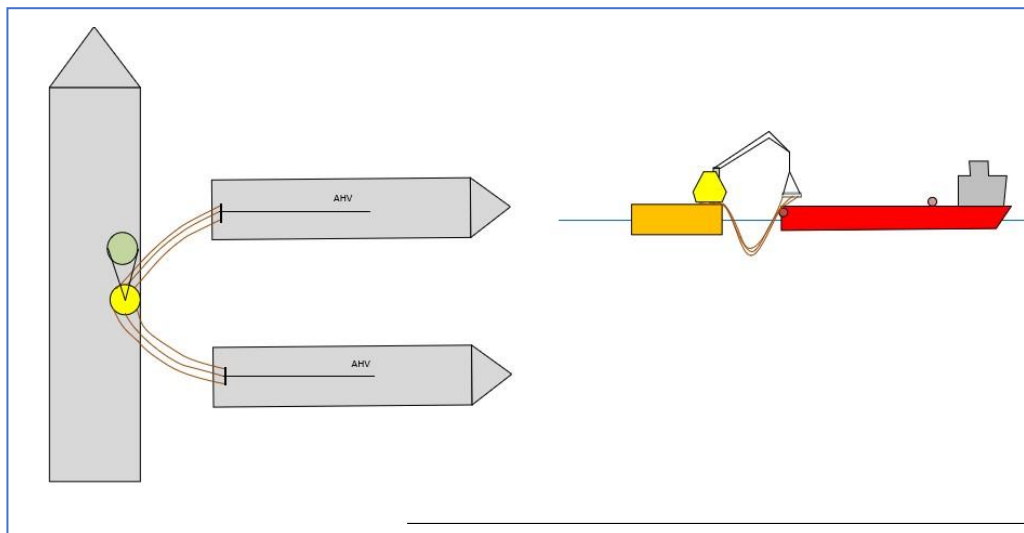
Tipico dell'operazione di sollevamento e collegamento dei cavi in acciaio alle barre di sollevamento dei 2 AHV
